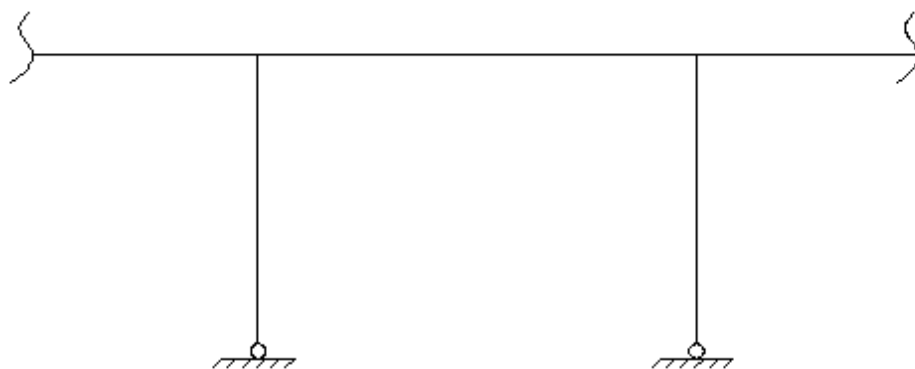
Розрахункова схема у поперечному напрямку.
